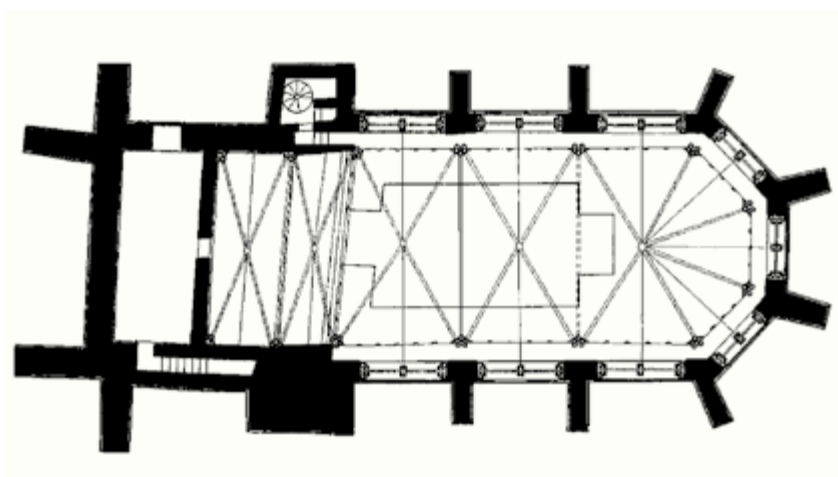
Grundrissrekonstruktion der Capella Speciosa von Klosterneuburg
